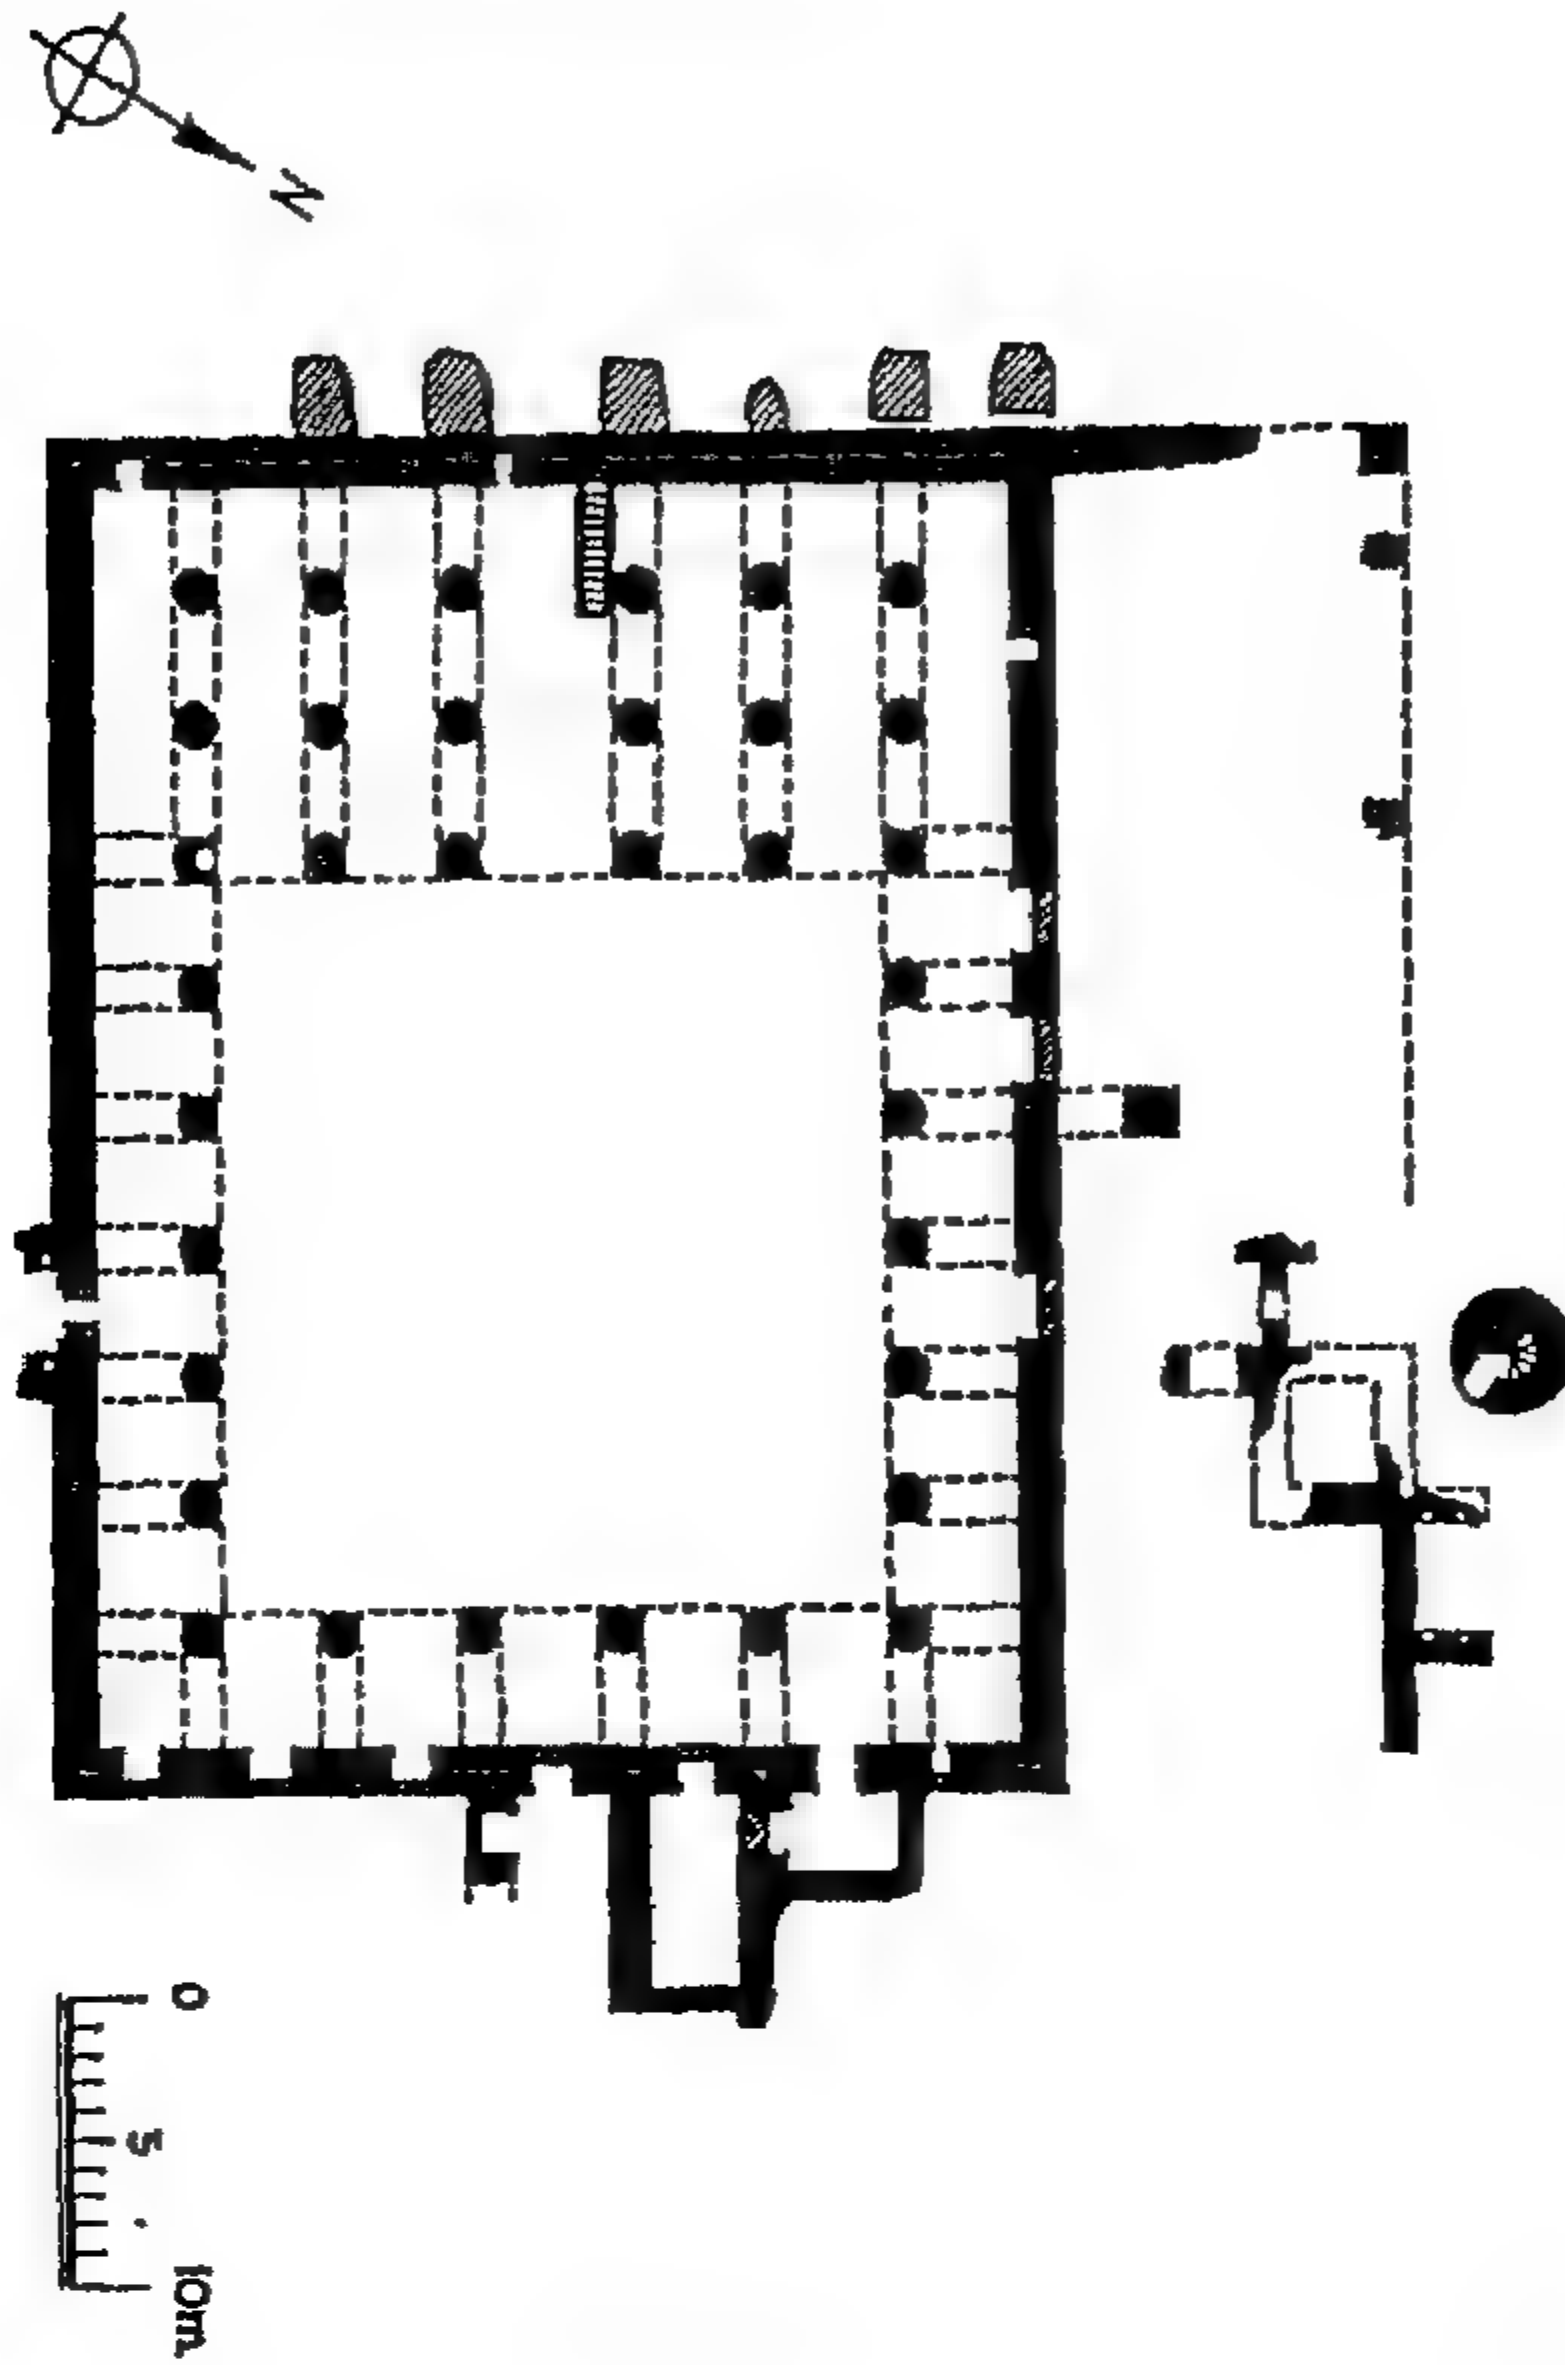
مسقط أفقي لمسجد Adina
